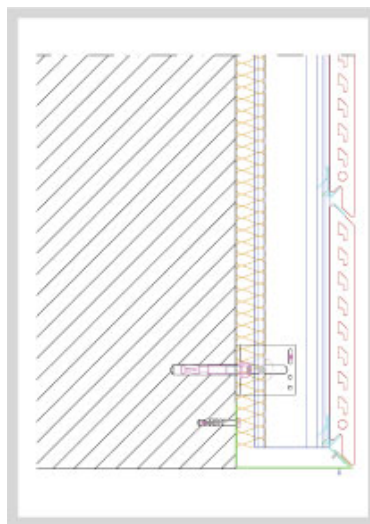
Aplicação da fachada ventilada – Remate de fundo [47]
